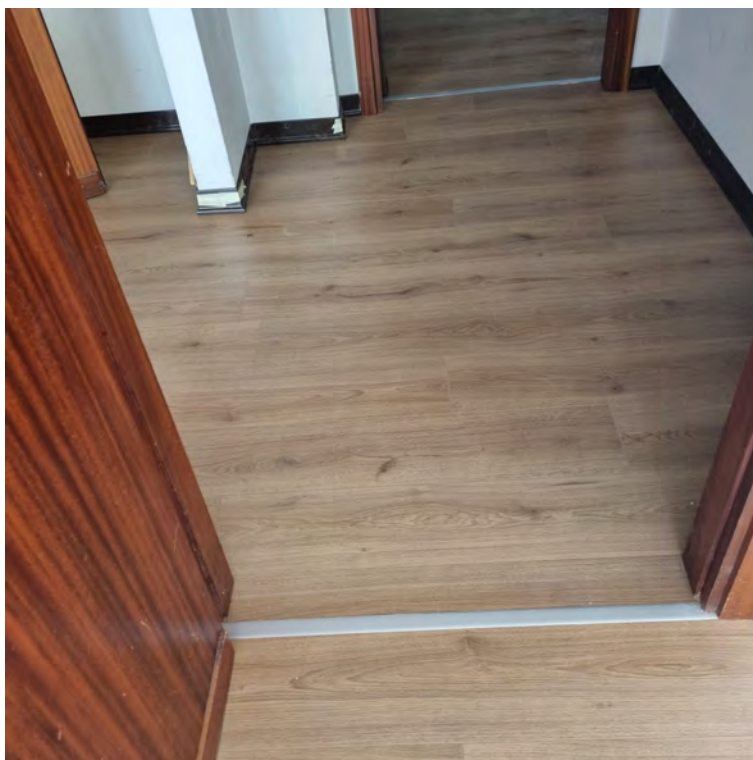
vista pavimentazione corridoio dopo il confinamento
